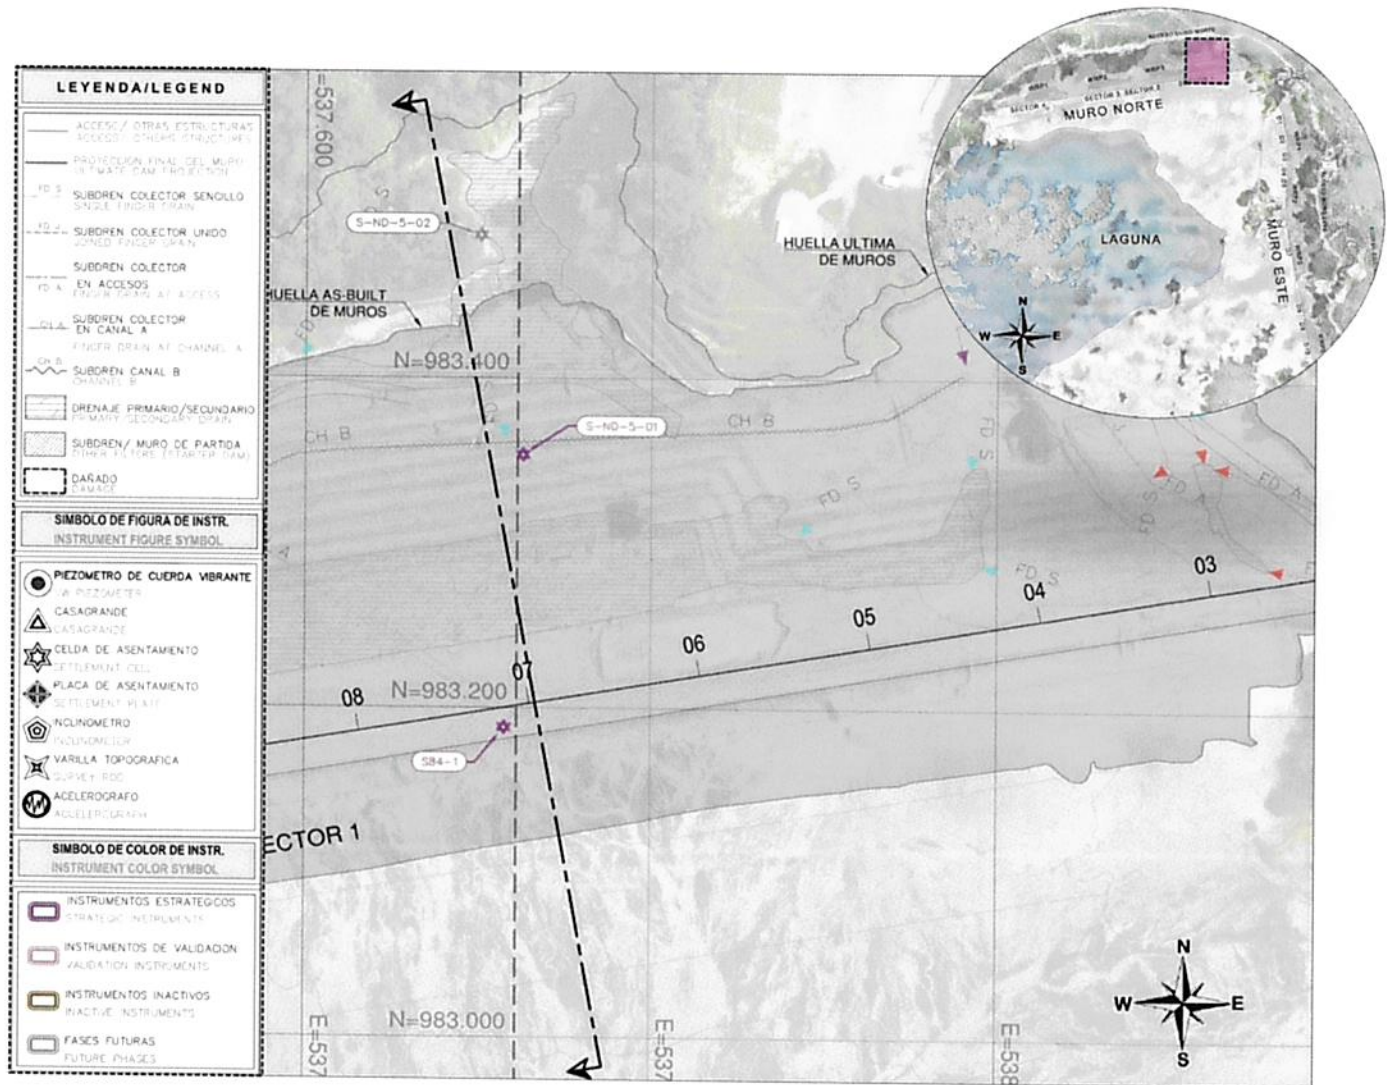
Vista de Planta en el Muro Norte Sector 1 con las Celdas de Asentamiento
